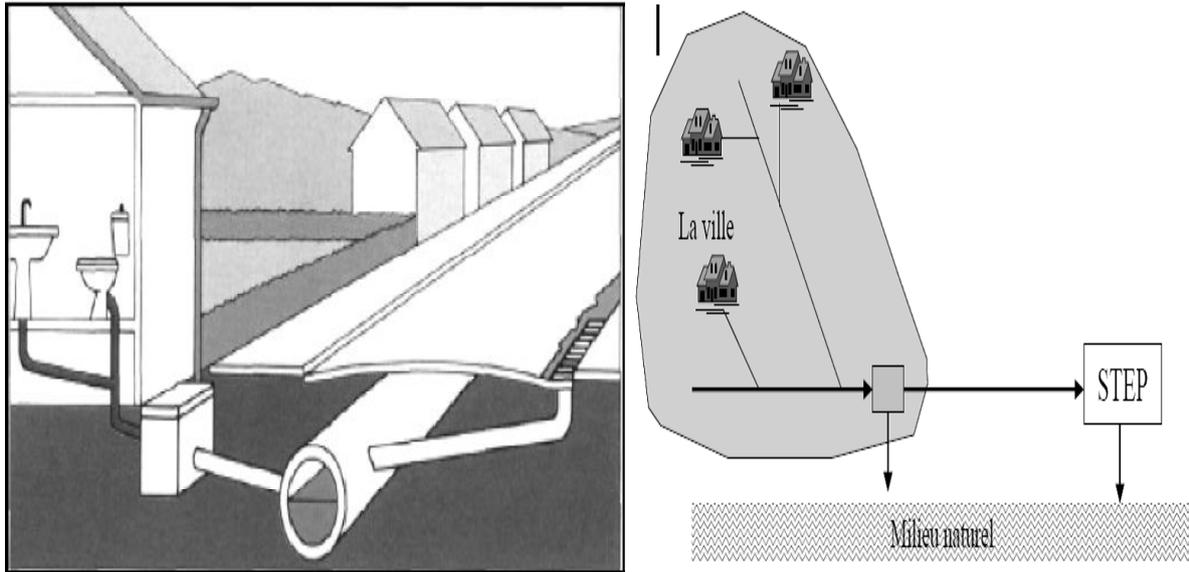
Schéma de principe d'un système unitaire (Seddiki, 2019)
